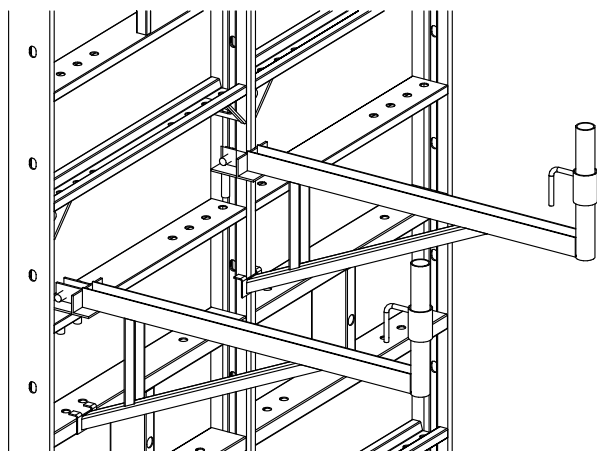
Пример возможной установки рабочего помоста на опалубку
